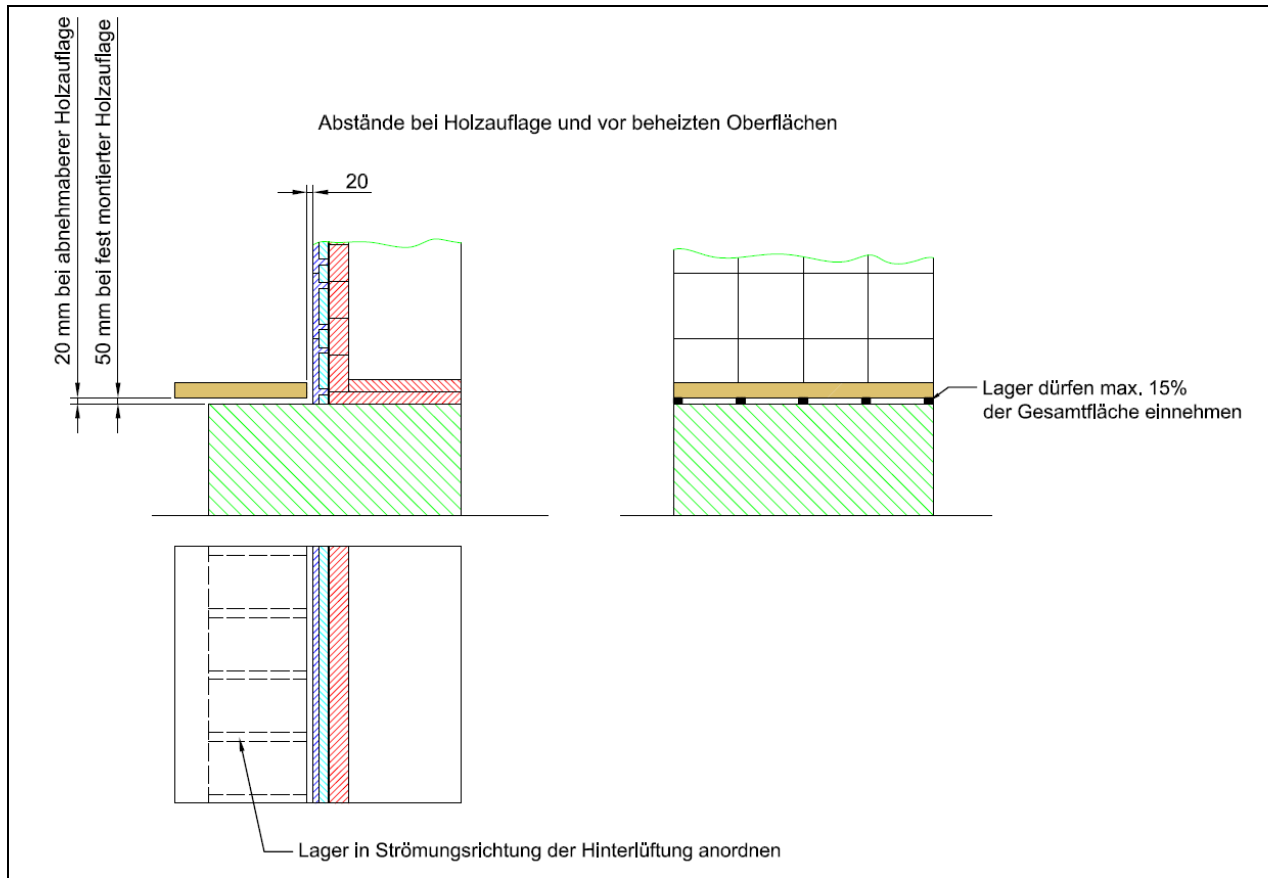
Holzauflage vor beheizter Oberfläche (Maße in mm)
